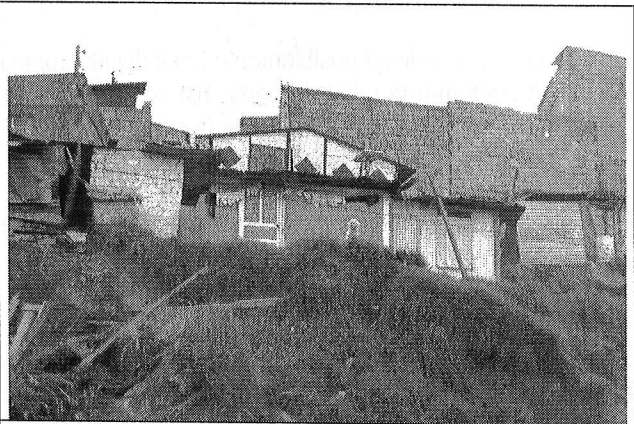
Vivienda de la Diagonal 67 Sur No. 82A-15 – Mz 1 Lote 1.
